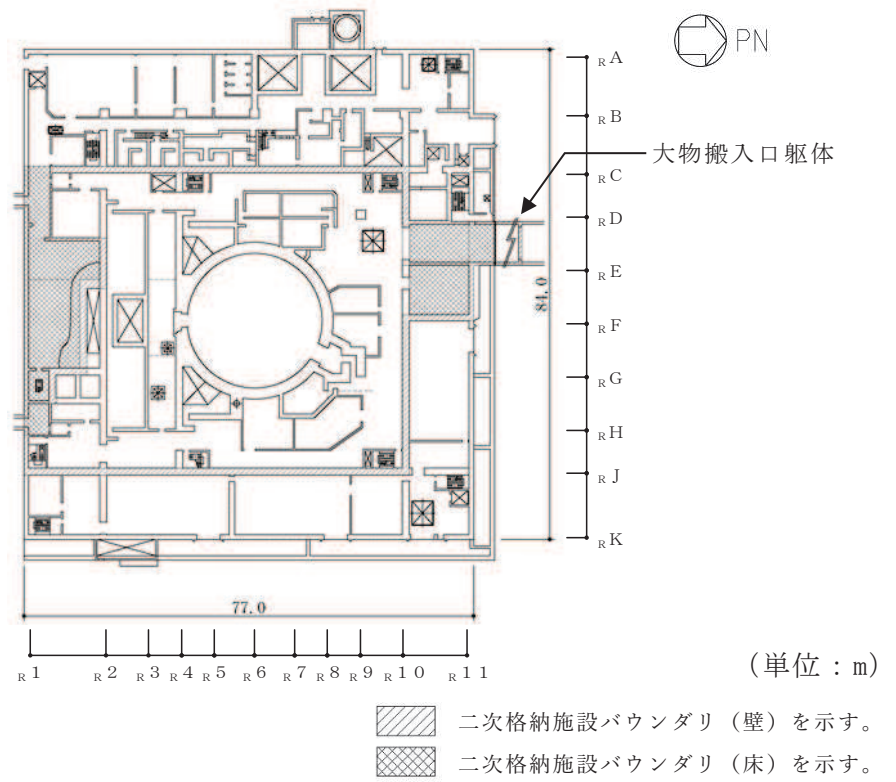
原子炉建屋原子炉棟（二次格納施設）の範囲の平面図
